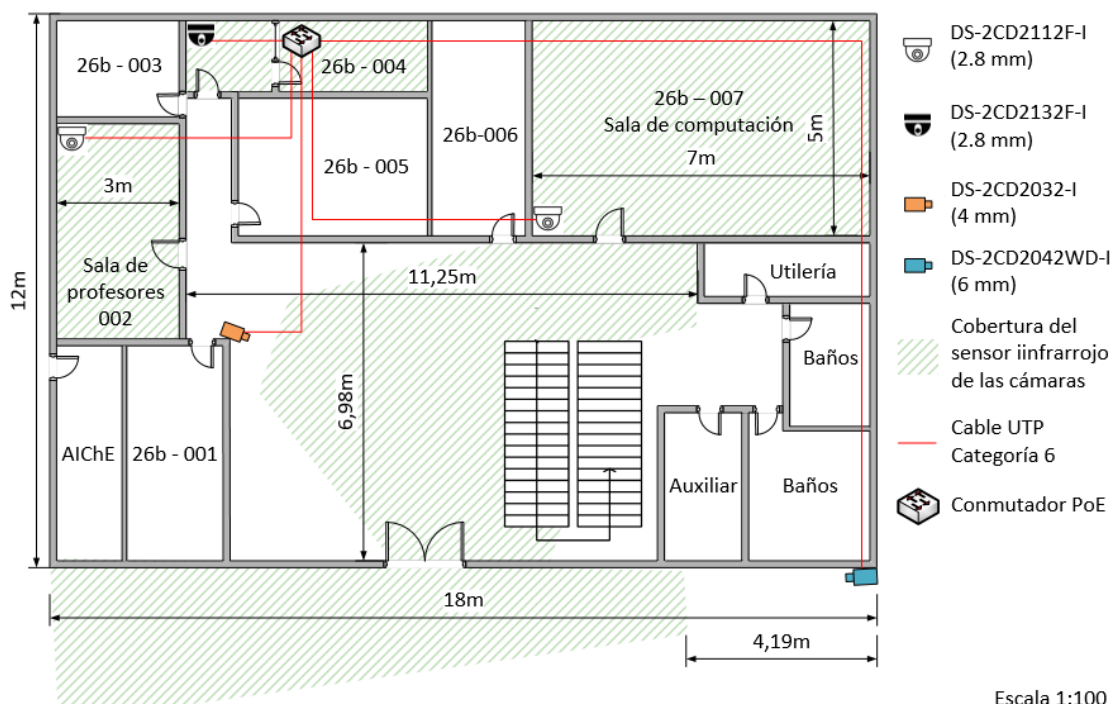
Ubicación de las cámaras en el edificio de Subdecanato 26 AB, planta baja.
